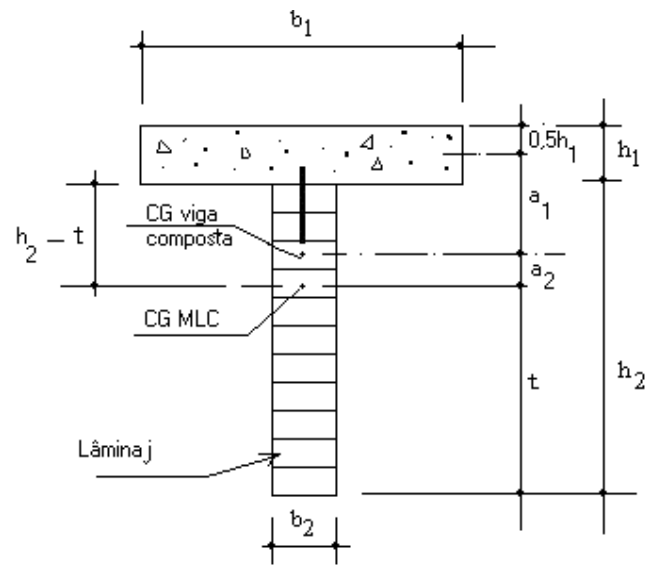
Seção transversal de viga mista MLC/concreto.
